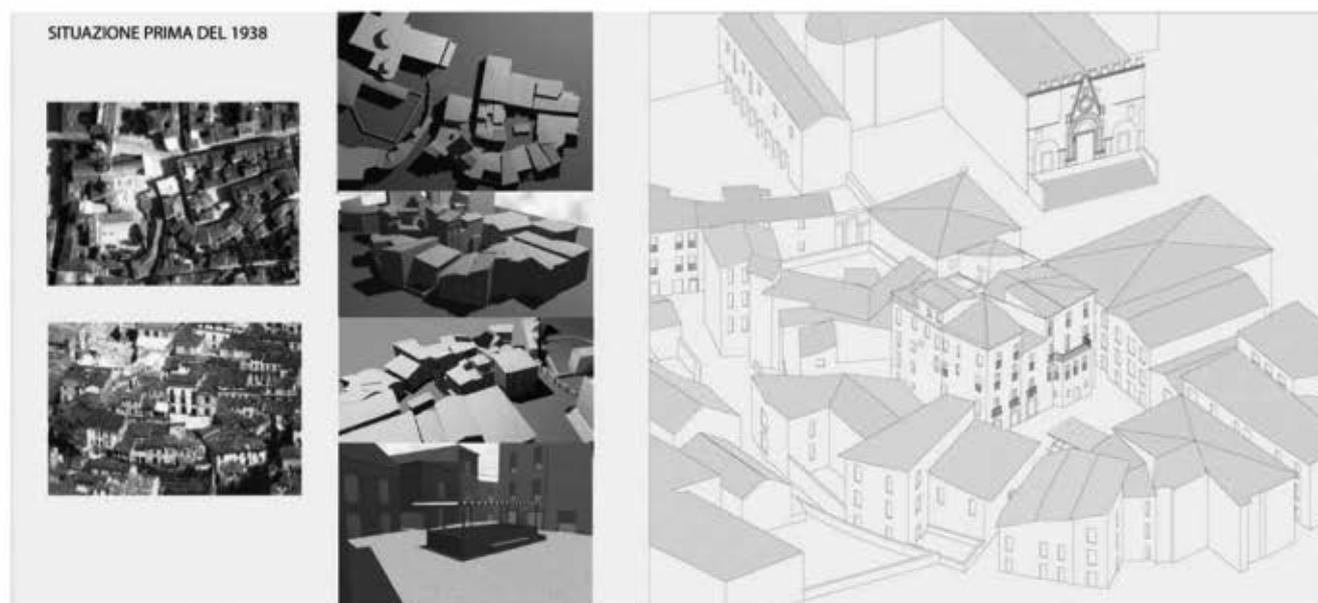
“ Ricostruzione “ grafica dell'impianto planimetrico
